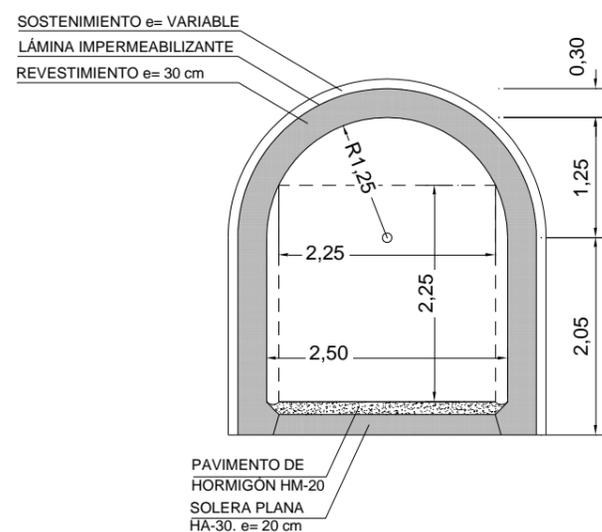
Sección tipo galería de emergencia Túnel de Colmenares
